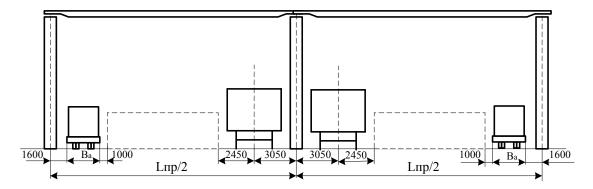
Поперечный разрез двухпролетного склада с мостовыми кранами (автопроезды продольные)
